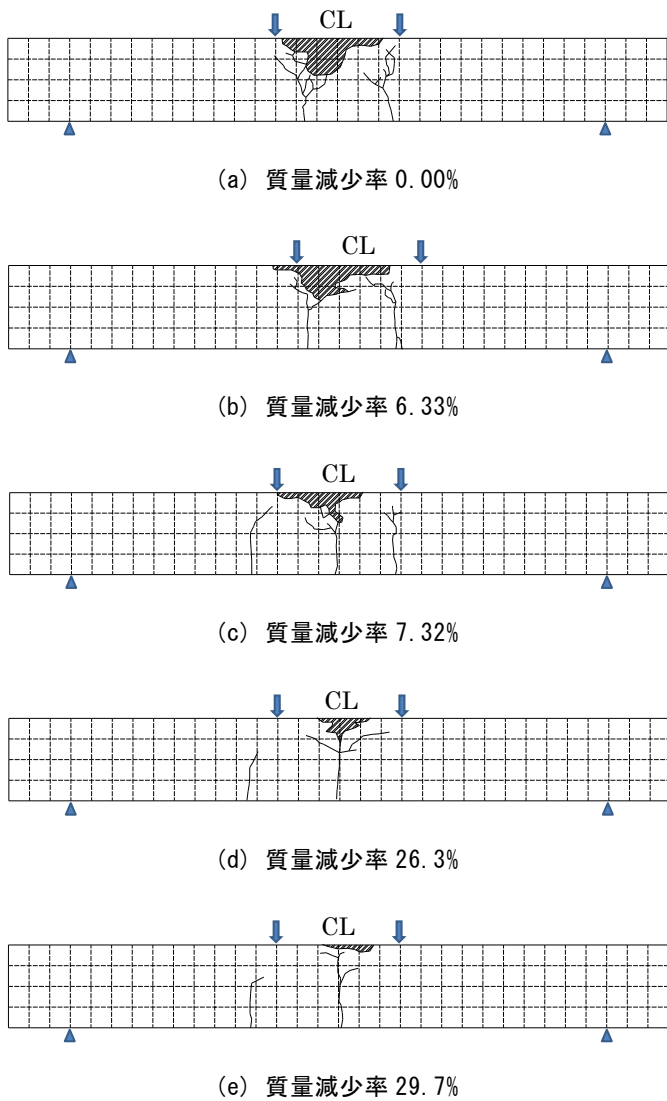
曲げ載荷試験後のひび割れ性状
